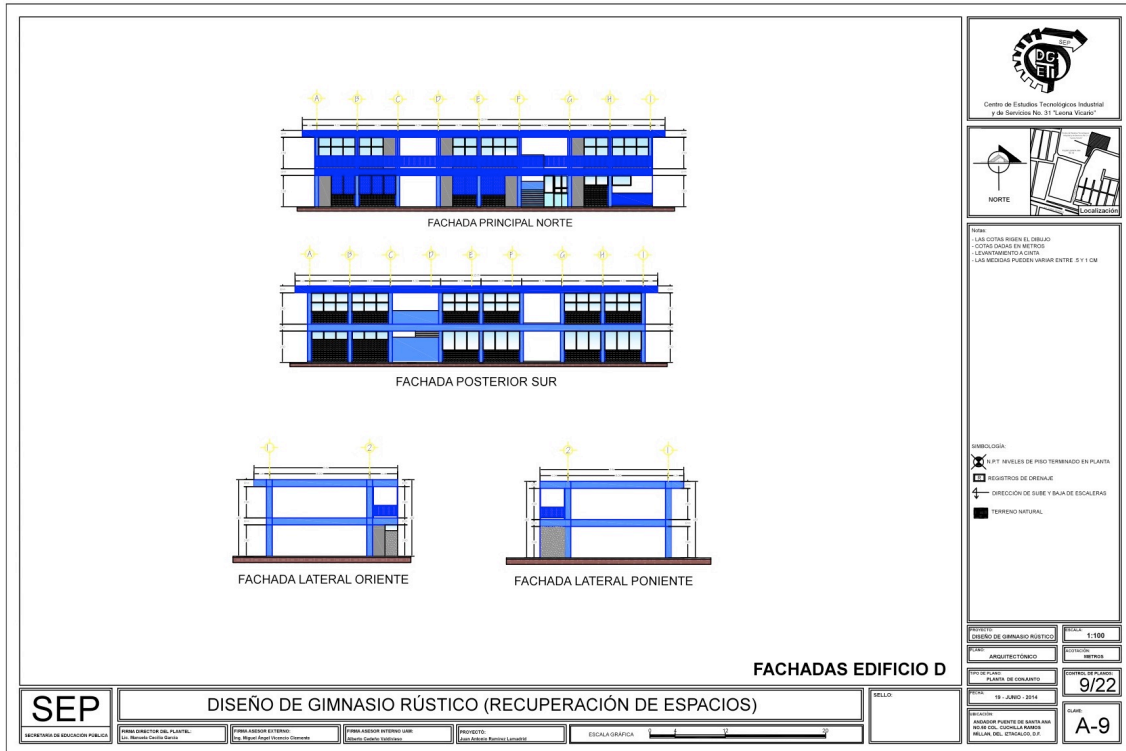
Fachadas edificio D, levantamiento por Juan Ramírez.
